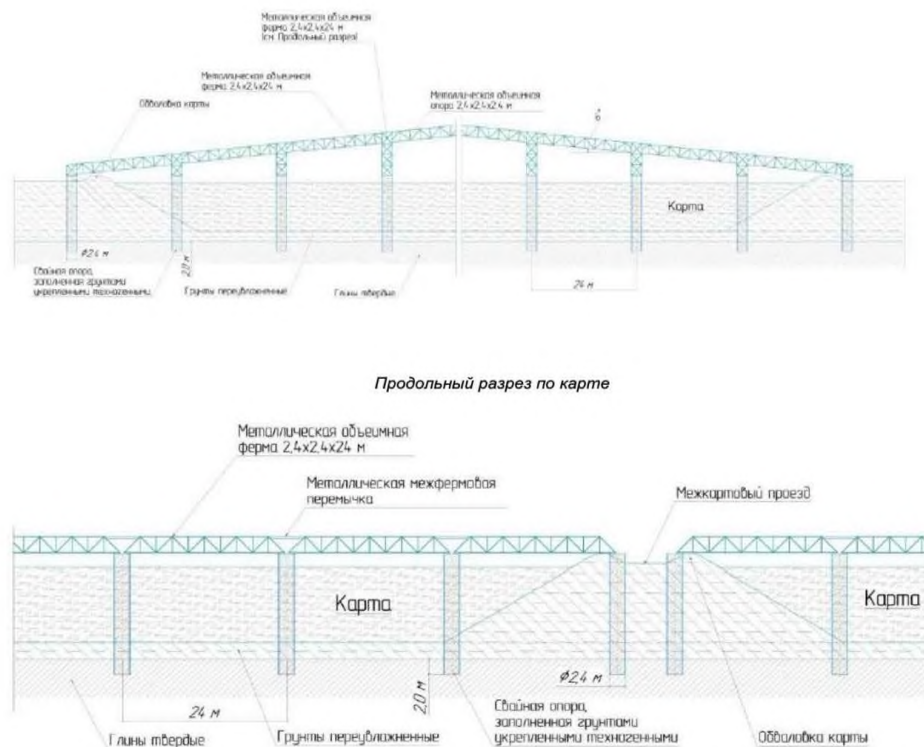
Укрытие с опиранием металлического каркаса на трубное свайное основание
